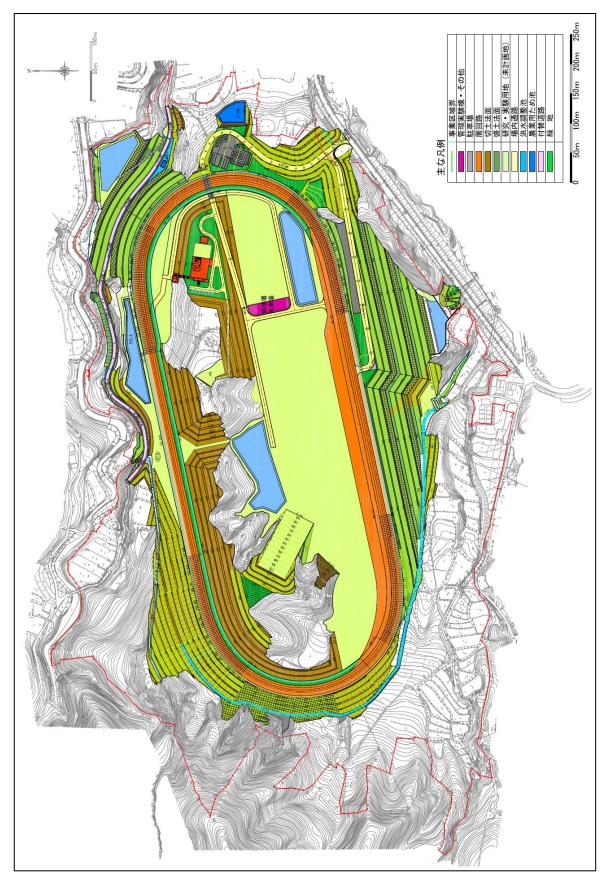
土地利用計画平面図(環境影響評価書時点)
